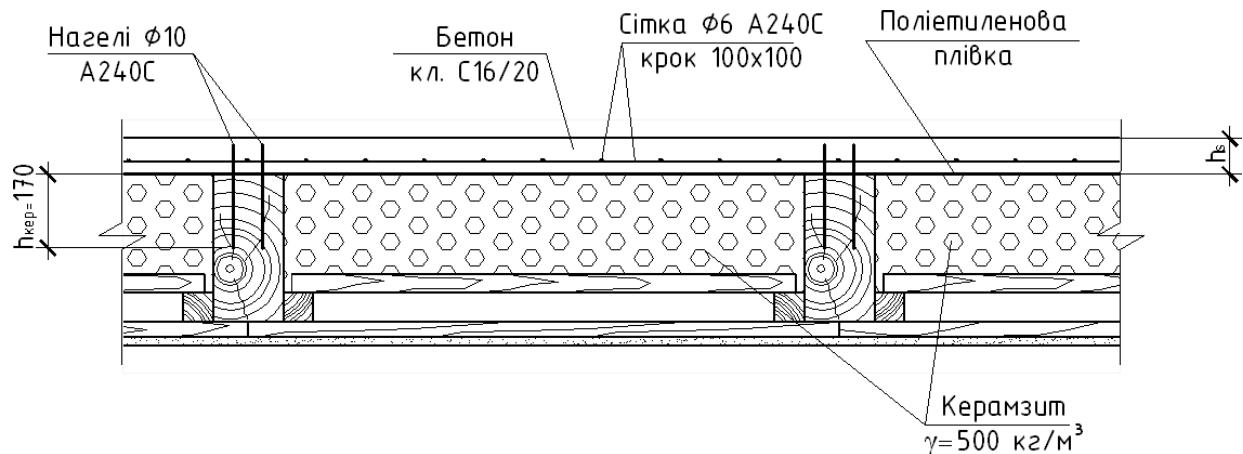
Конструкція підсилення дерев'яного перекриття.
